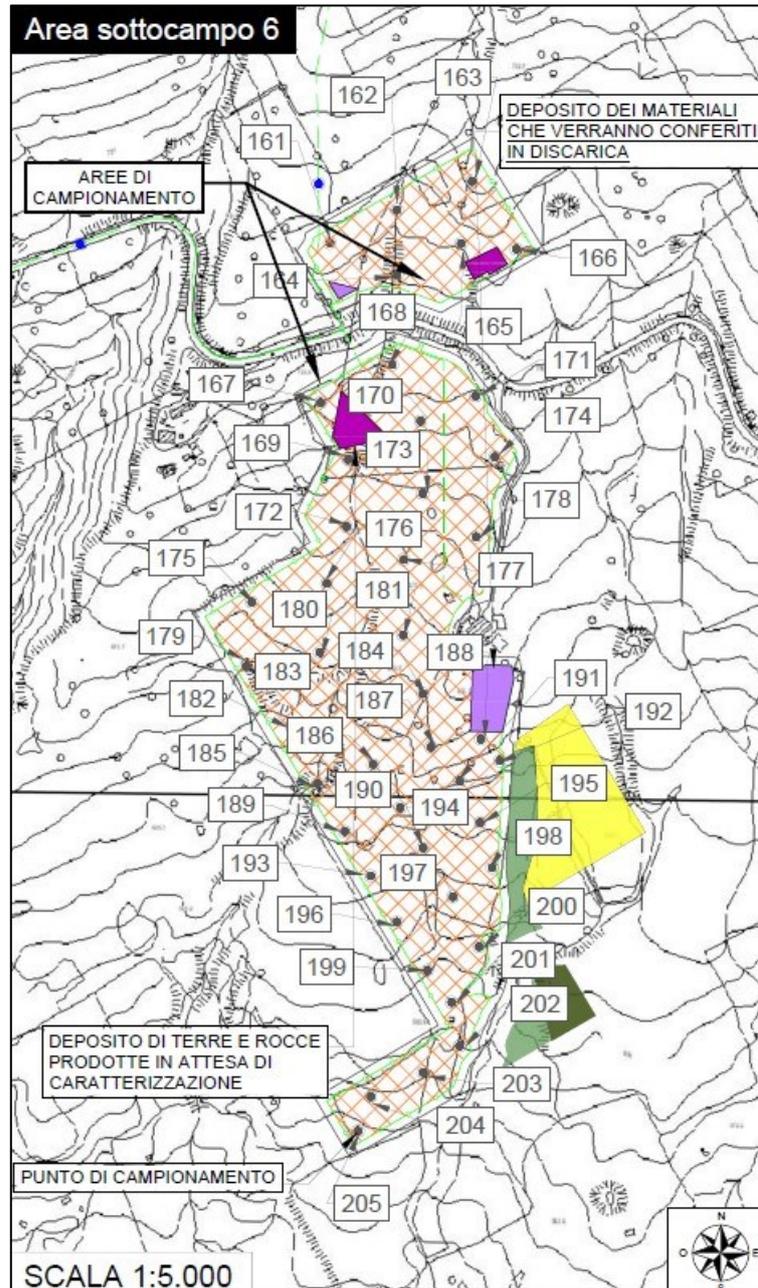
Planimetria sottocampo 6 con punti di campionamento
